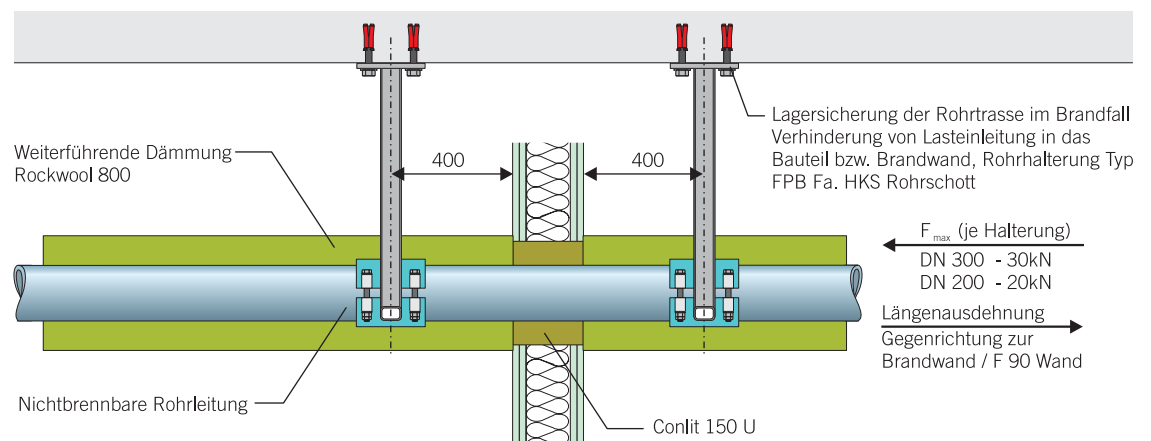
R 90 Rohrabstüttung, Brandwand/F 90 Wand (leichte Trennwand mit runder Aussparung) Einfachrohrdurchführung nichtbrennbarer Rohrleitung DN 200 bis DN 300
